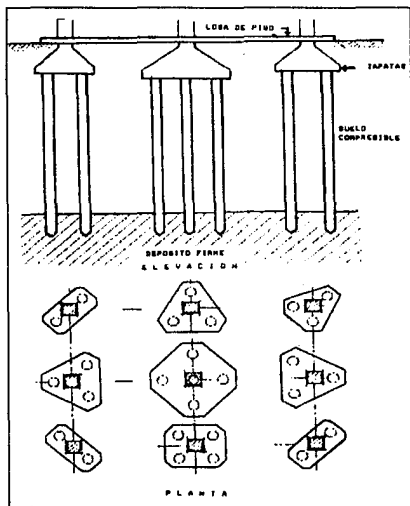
GRUPOS DE PILOTES DE PUNTA
